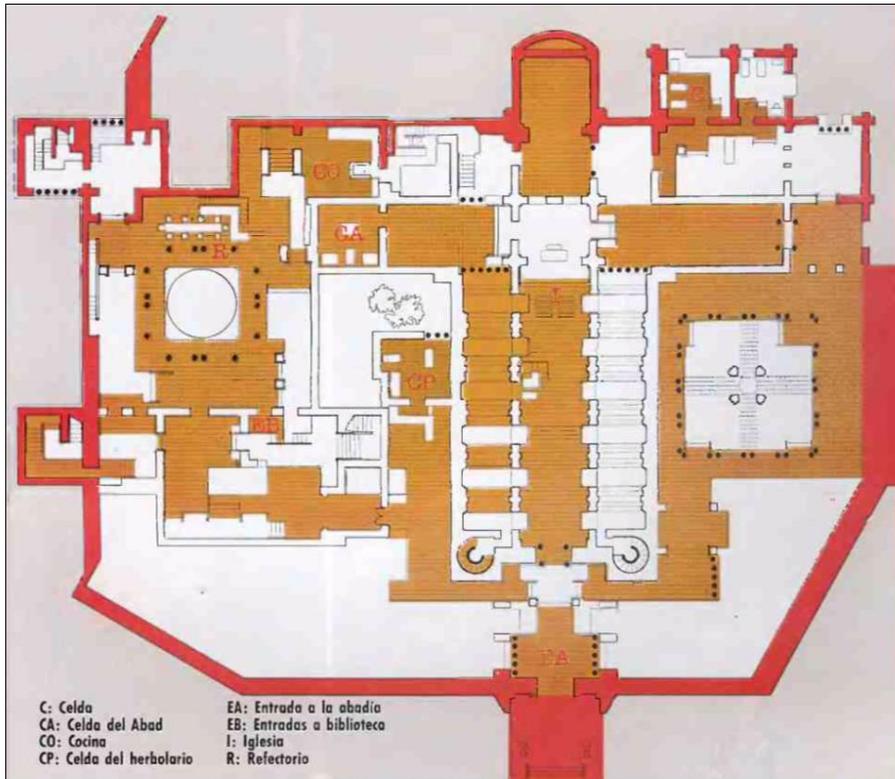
Plano del conjunto arquitectónico de *La Abadía del Crimen*.
